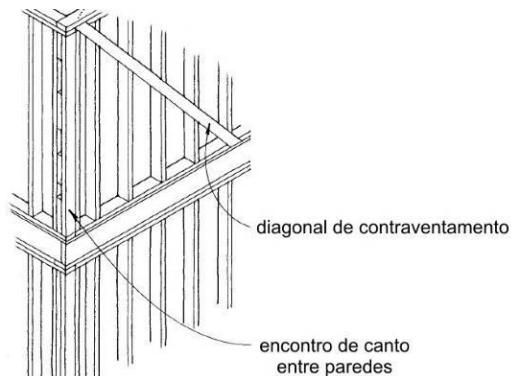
Diagonal de contraventamento da ossatura da parede no encontro de canto.
